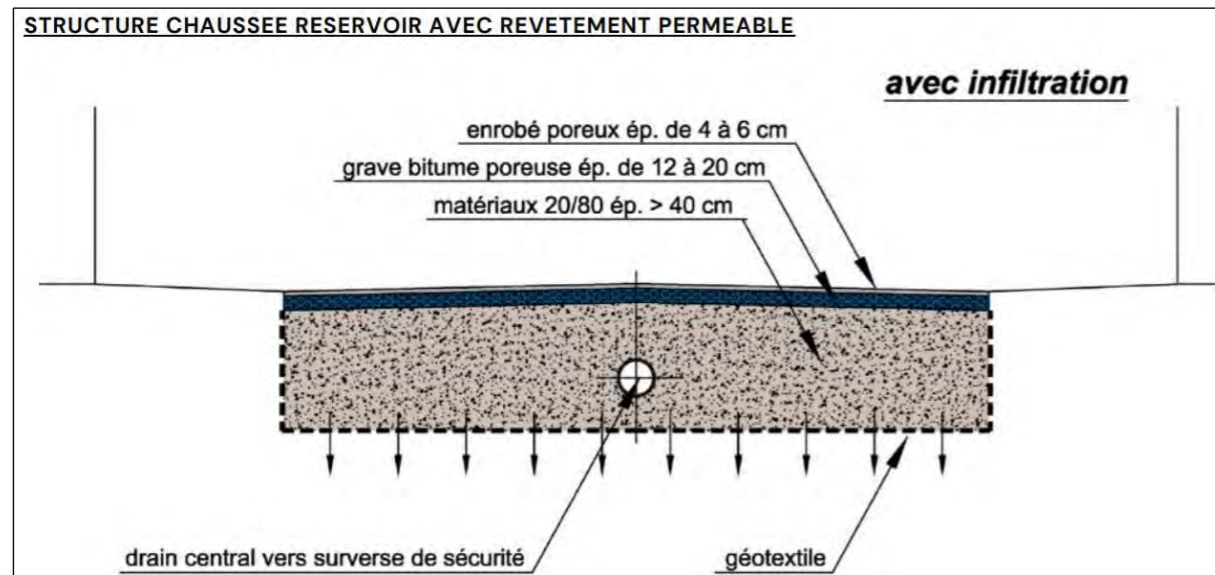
Exemple de structure réservoir avec enrobé drainant (perméable) et évacuation par infiltration (source : CETE Nord - Picardie)
